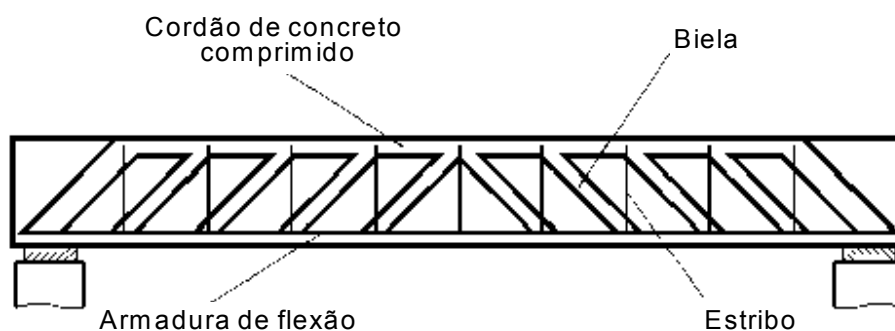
Treliça de Morsch – FONTE: Pinheiro, 2007
